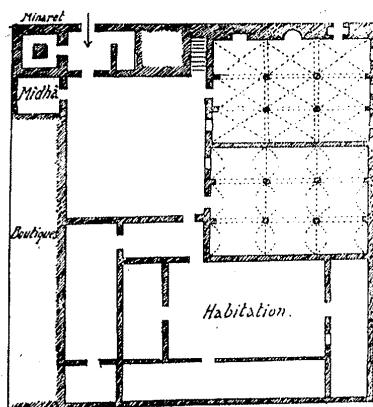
مسقط أفقى لجامع الهداء بتونس.
